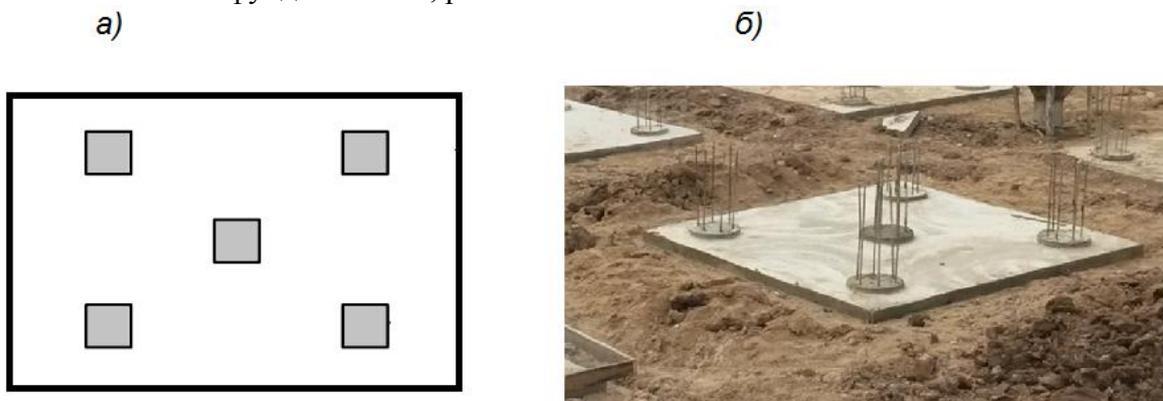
Свайный куст: а) – схема расположения свай в кусте из пяти готовых свай; б) – свайный куст из набивных свай
